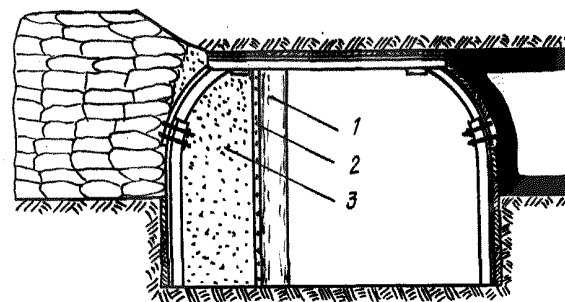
Изолирующая стенка из пенопласта при охране выработки переносной органной крепью:
